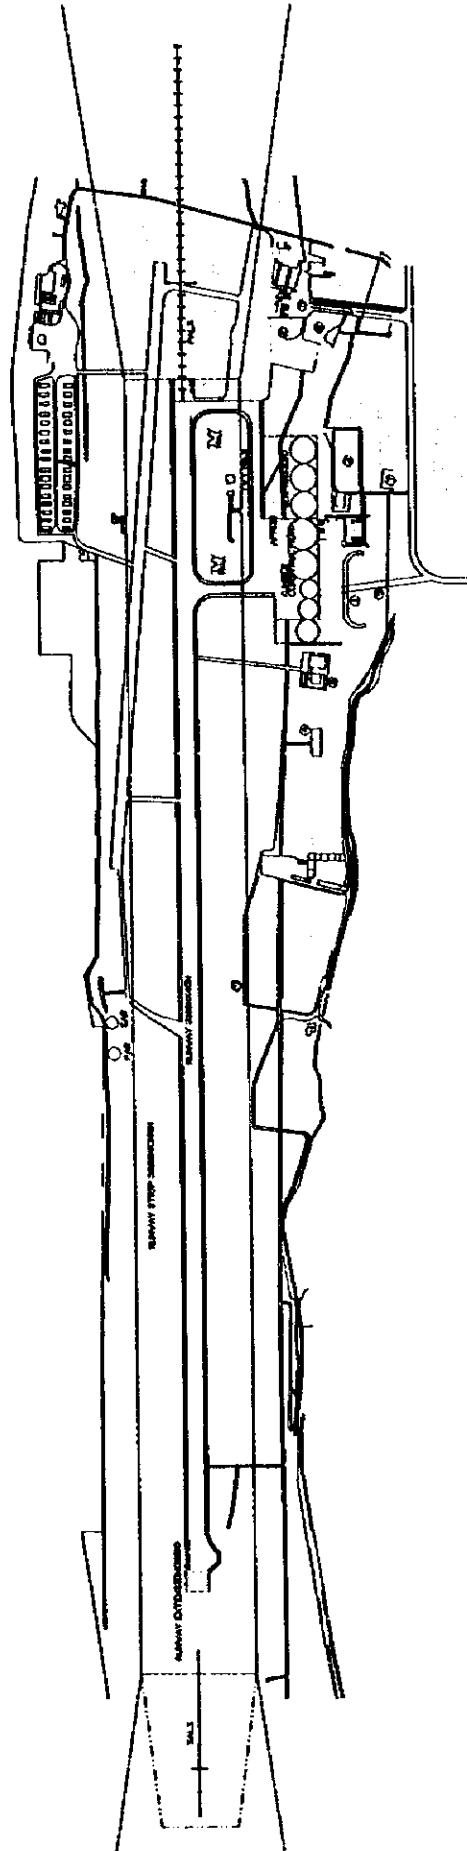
ブハラ空港施設設計画平面図 (2020 年)
